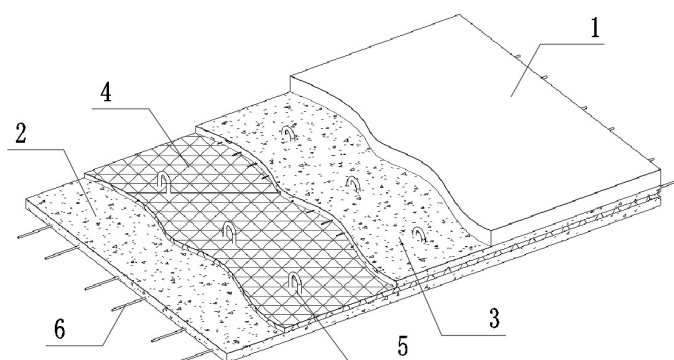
装配式混凝土夹芯叠合楼板构造示意
